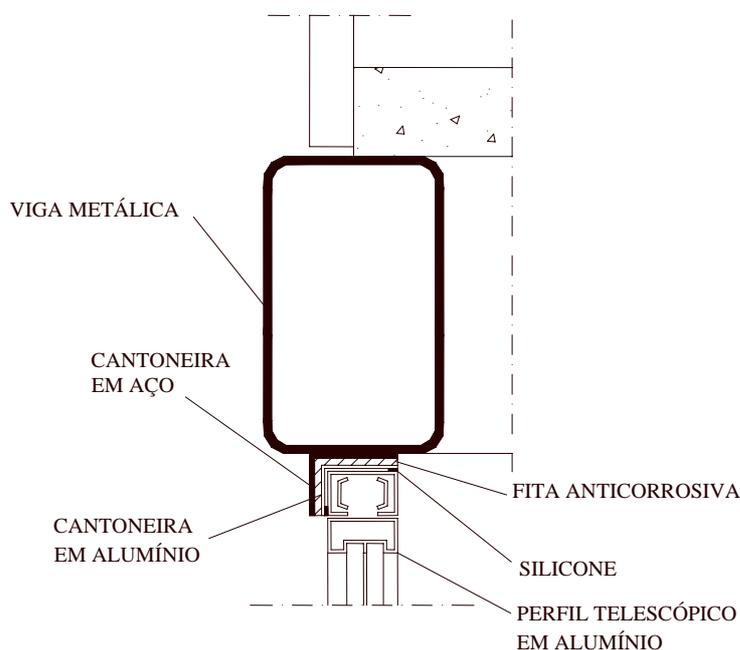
Seção 3-3: Detalhe da junção do caixilho com a viga metálica.
